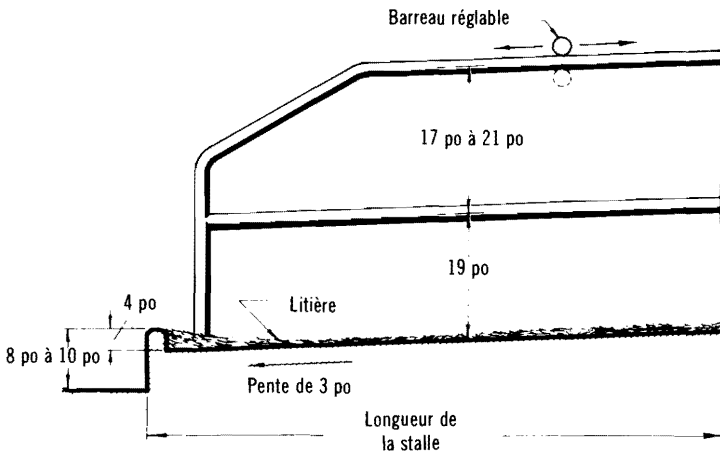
O Stalle libre sur plate-forme pavée surélevée
